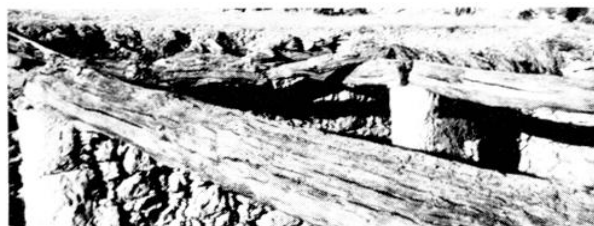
Poutres dans la charpente d'un toit plat (Raachine, Liban).
